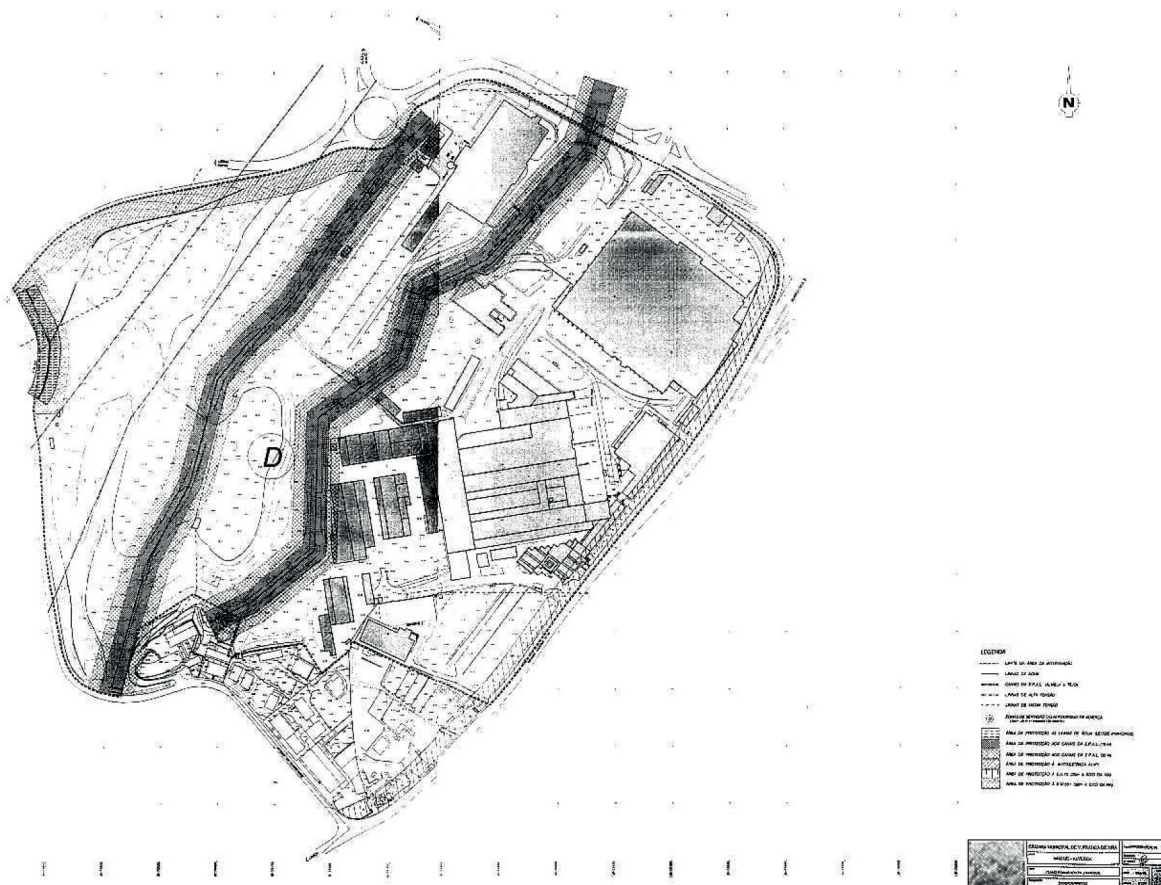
| Planta de implantação antes do projeto, MAGUE.
